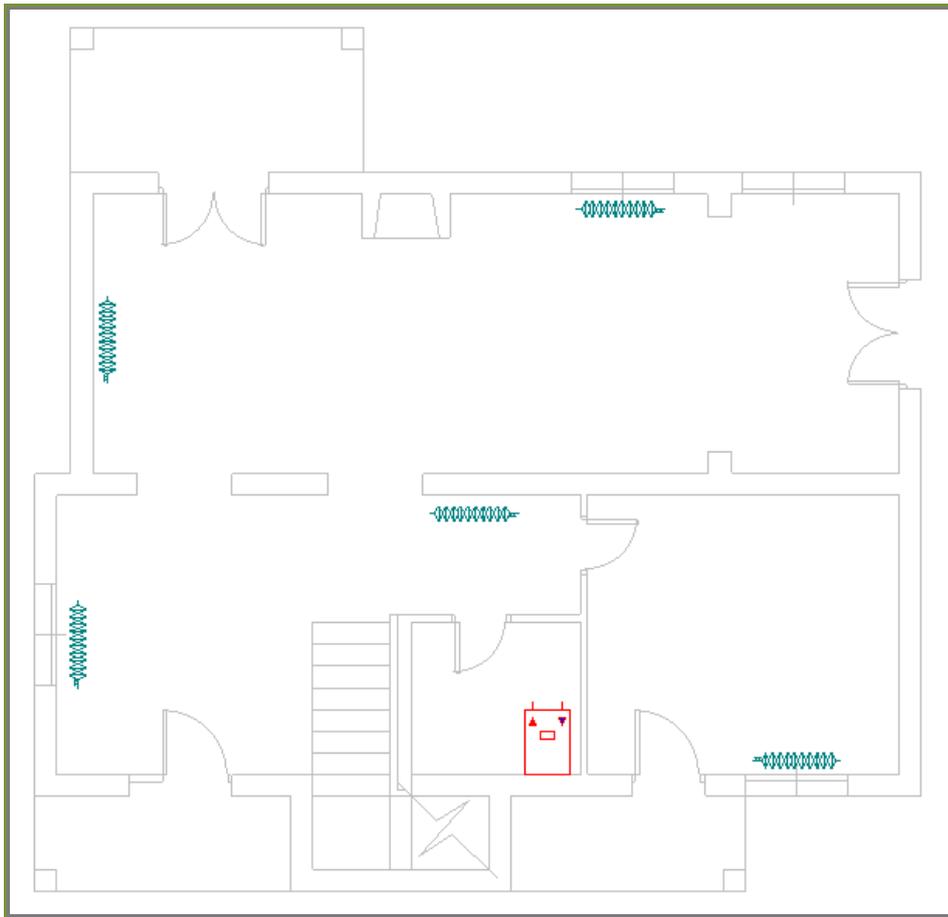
Posición de los símbolos de radiadores bitubo en planta baja.
